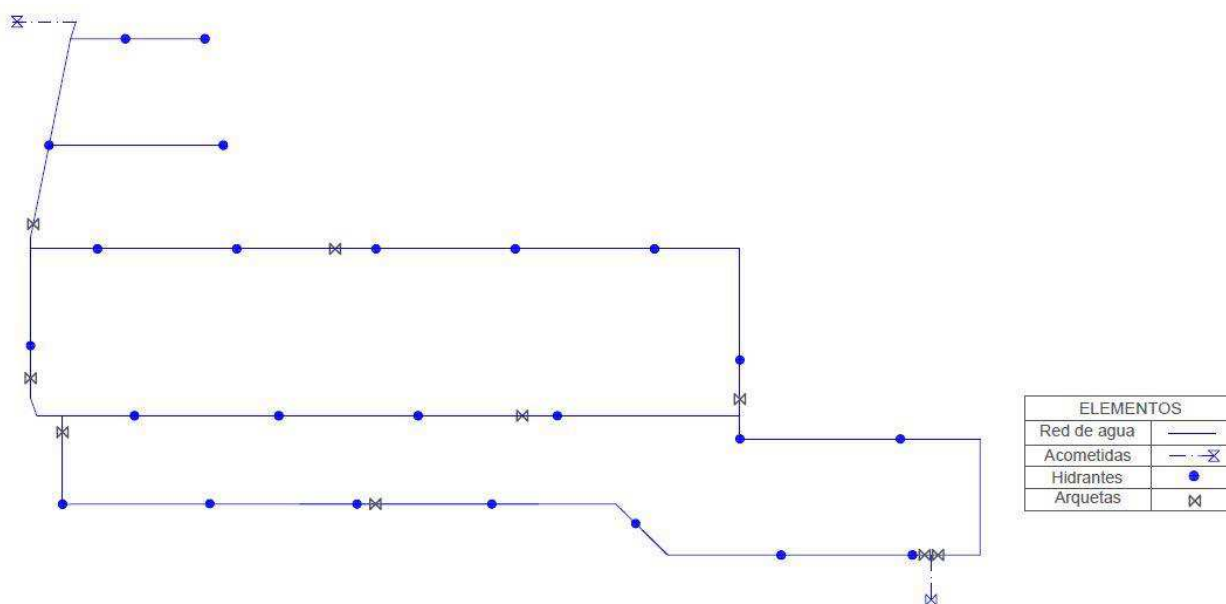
Distribución de los hidrantes y las válvulas sectorizadas
